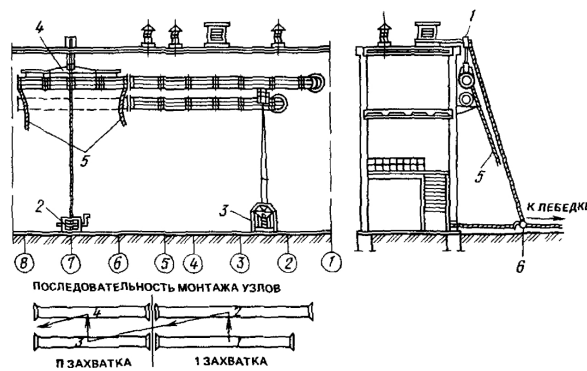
Схема организации рабочей зоны при монтаже воздуховодов по наружной стене здания: 1 - консоль с блоком; 2 - лебедка; 3 - автогидроподъемник; 4 - траверса; 5 - оттяжка; 6 - блок
